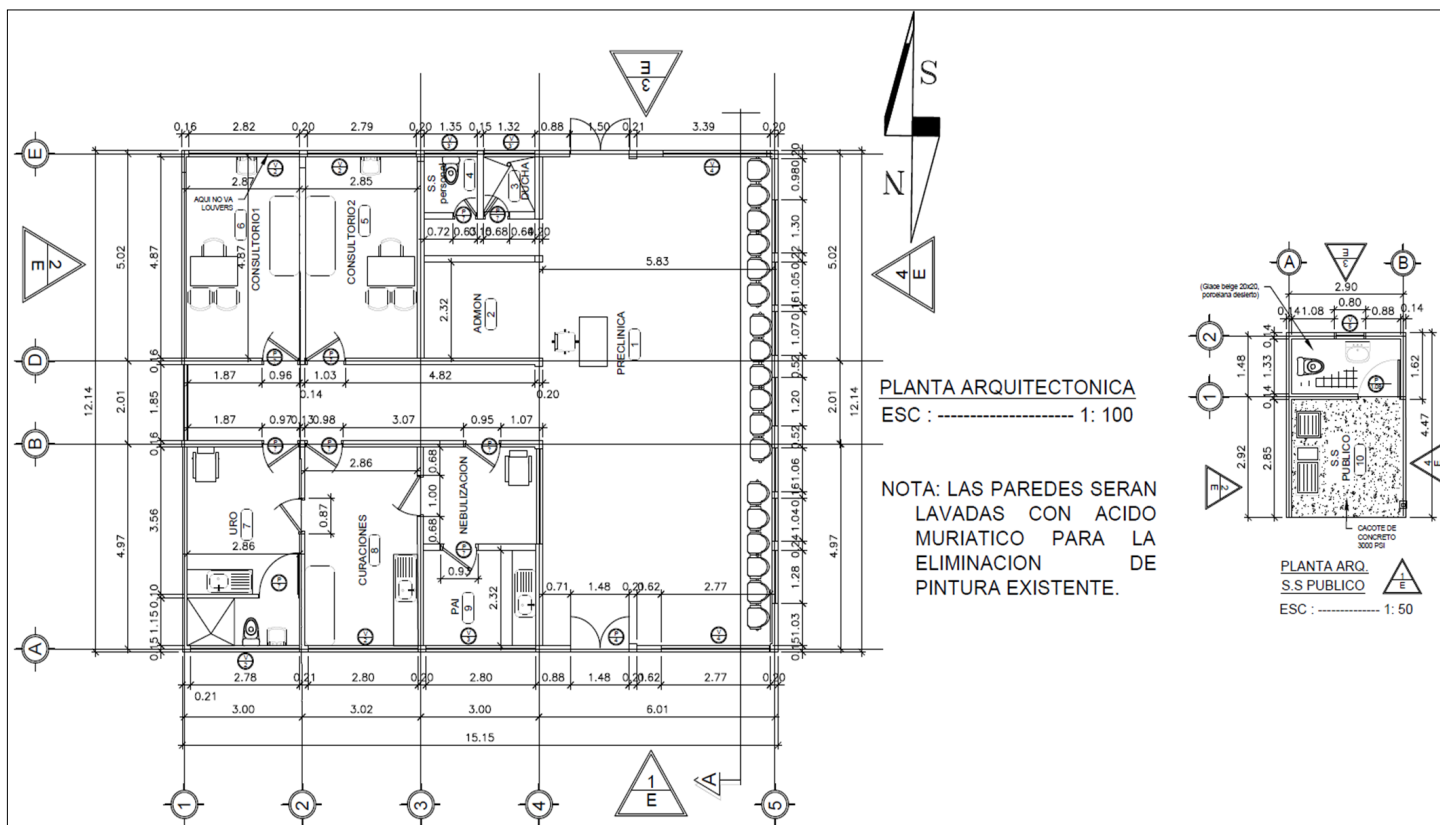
Planta Arquitectónica puesto de salud Villa San Jacinto/Fuente: Elaboración propia.
